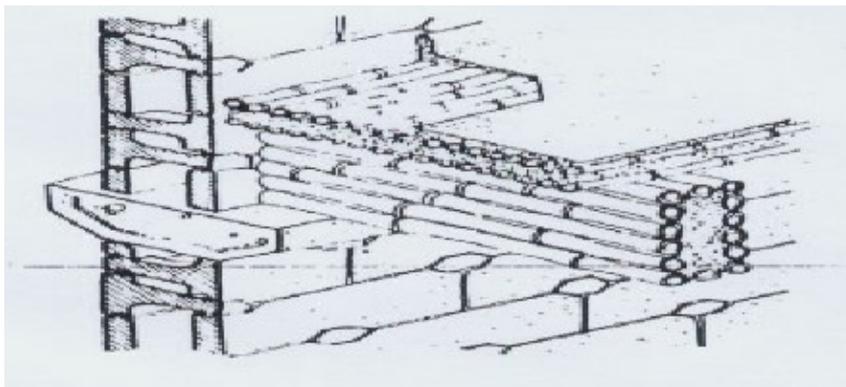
Vigas e laje de bambu recheadas com espuma de poliuretano.
